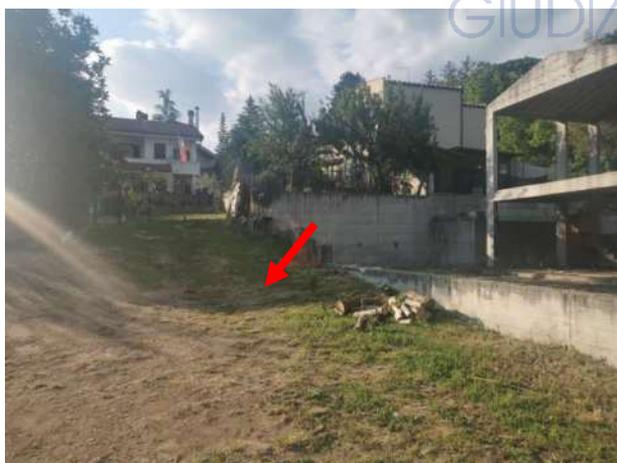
Foglio 75 Particella 593. Lotto di terreno.
